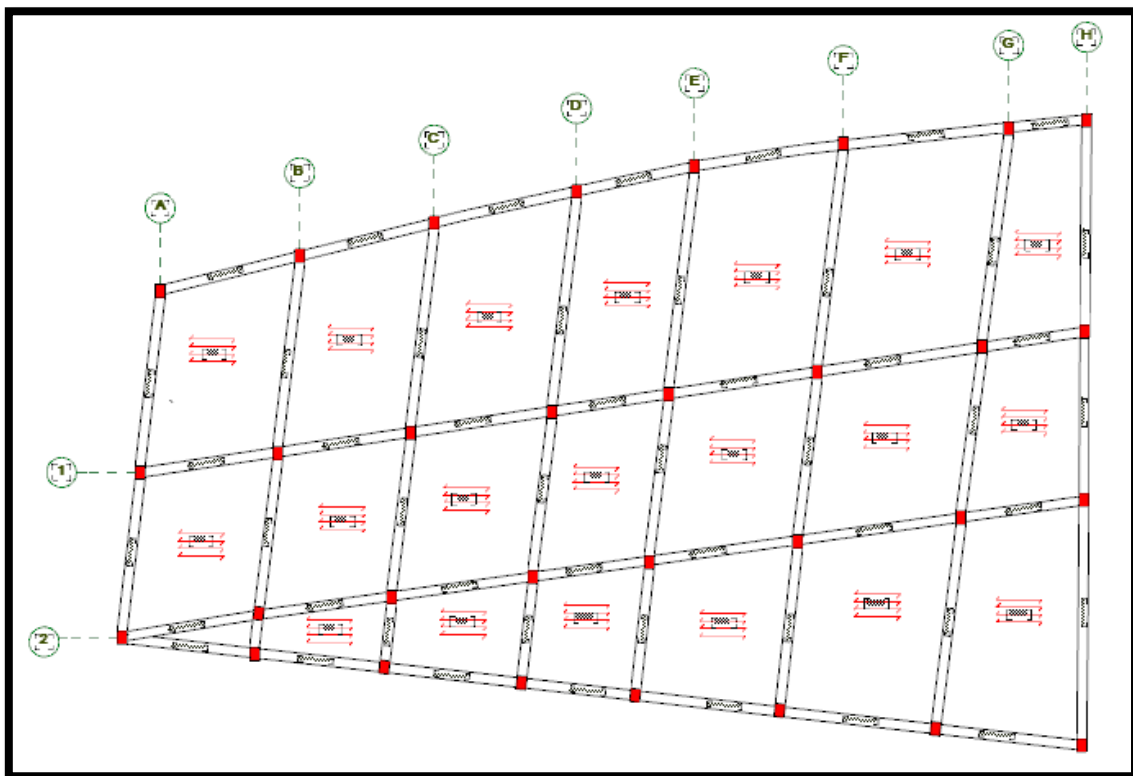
plan de plancher bloc 02 du musée Source : auteur
